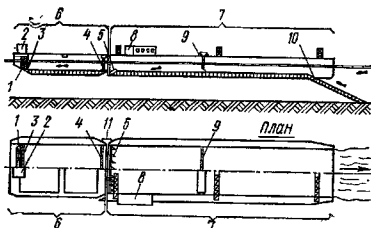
Плавающая установка для накопления и транспортировки рыб
